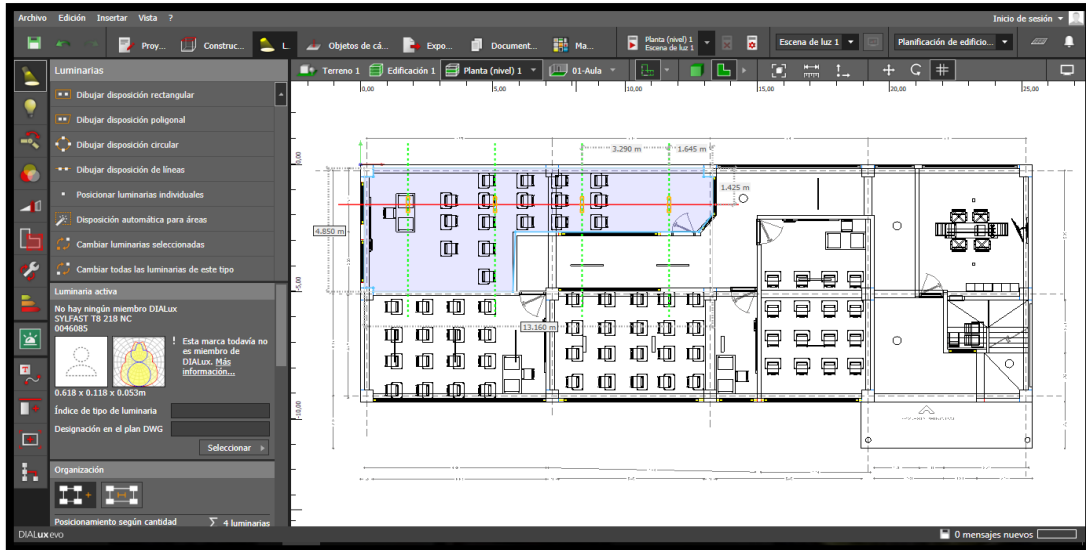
Implementación de las luminarias actuales en la planta baja correspondiente al aula 4.
